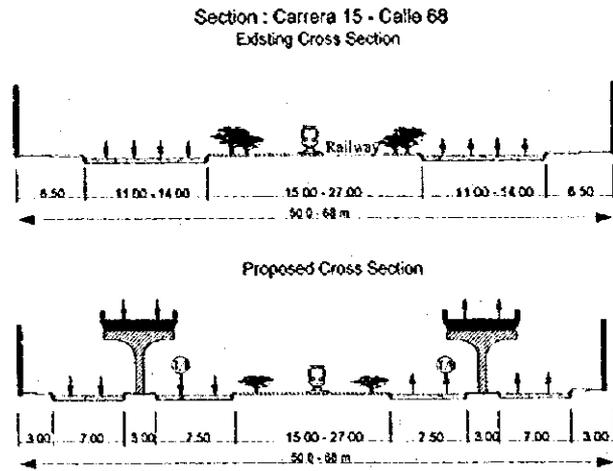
Sección Típica sobre la Avenida Quito (2)
